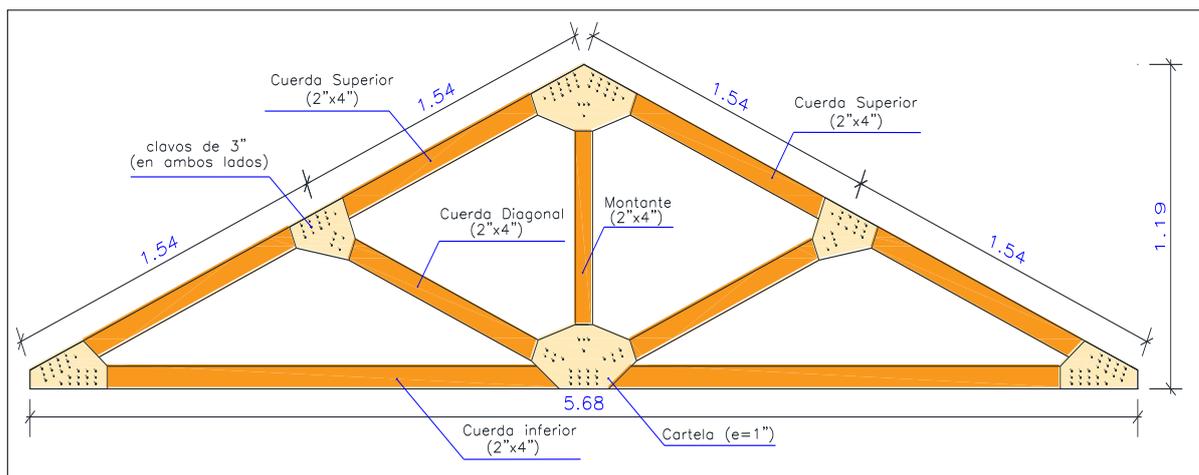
Armadura de madera tipo “Montante Maestro”
